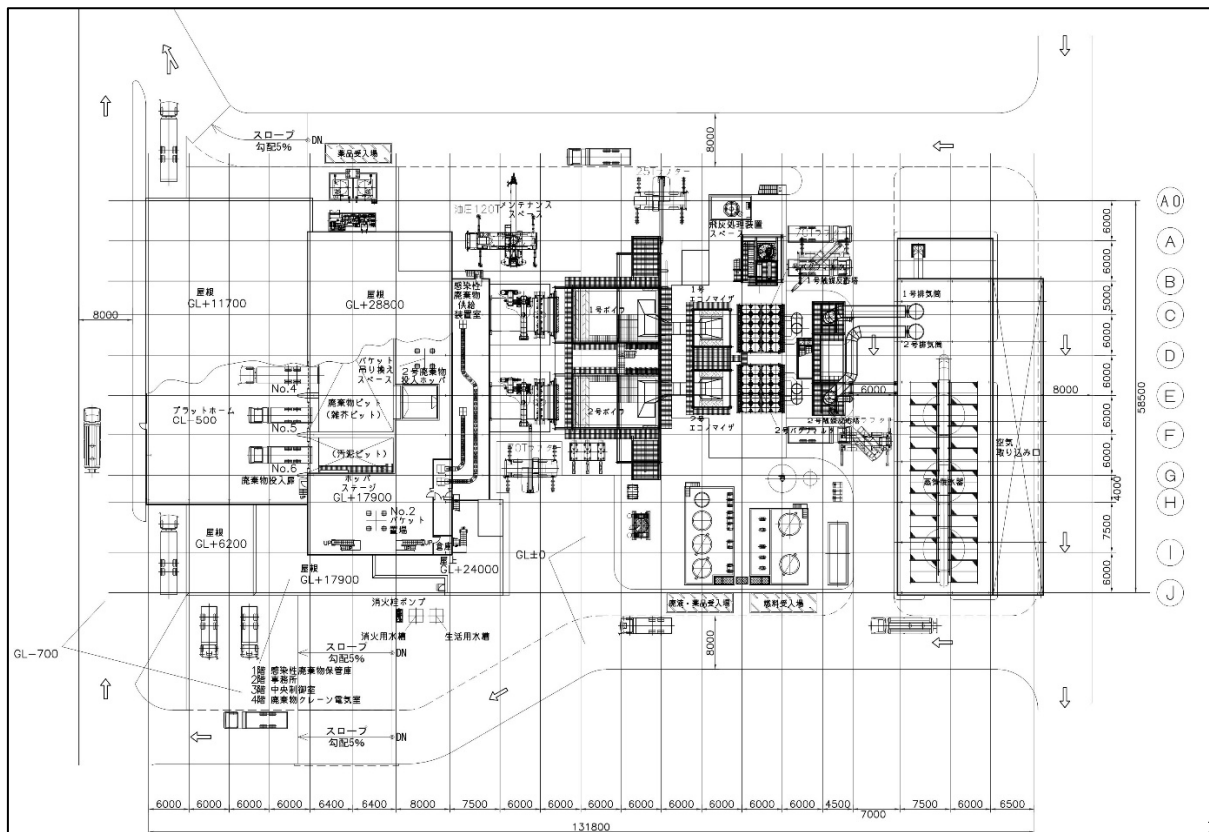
(2) 設備機器の平面図・断面図（エネルギー回収施設（焼却施設））
